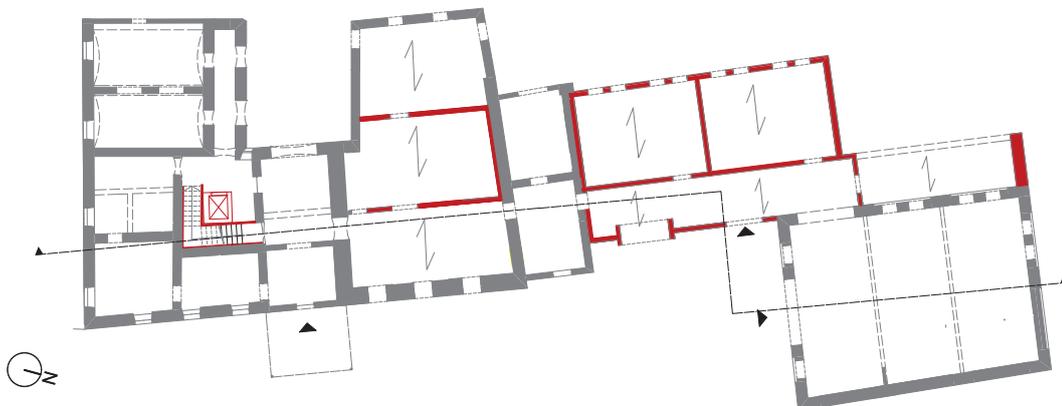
Statisches Gerüst Erdgeschoß M 1:500
